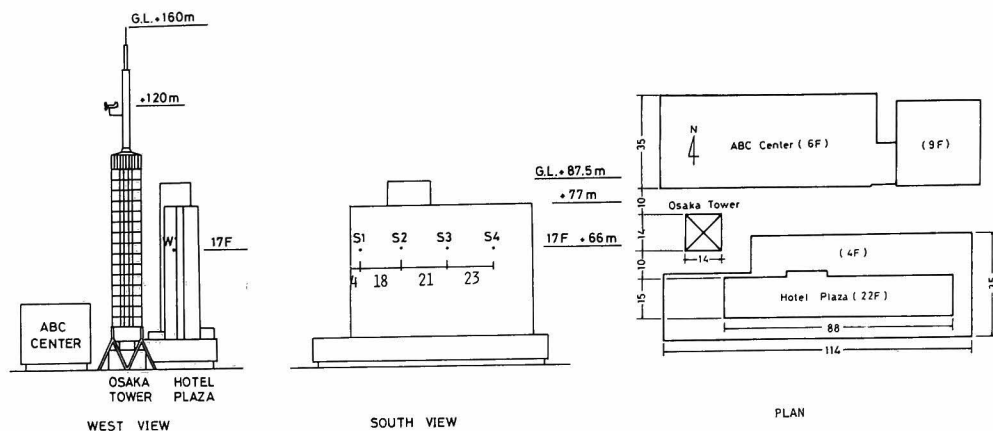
大阪ホテルプラザ立面図及び平面図
